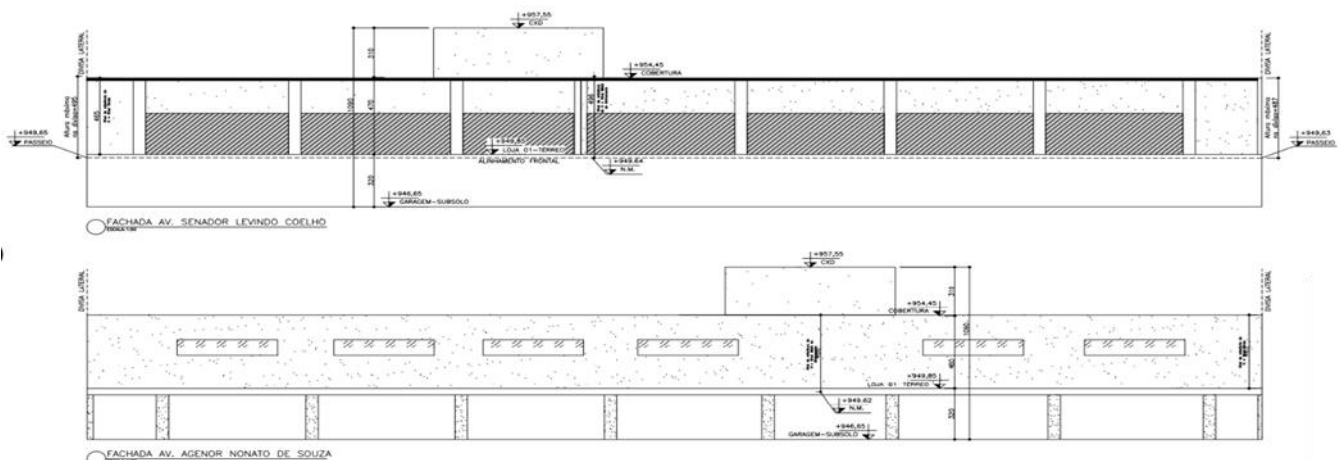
Perfil transversal das edificações: Subsolo e 1ª andar
